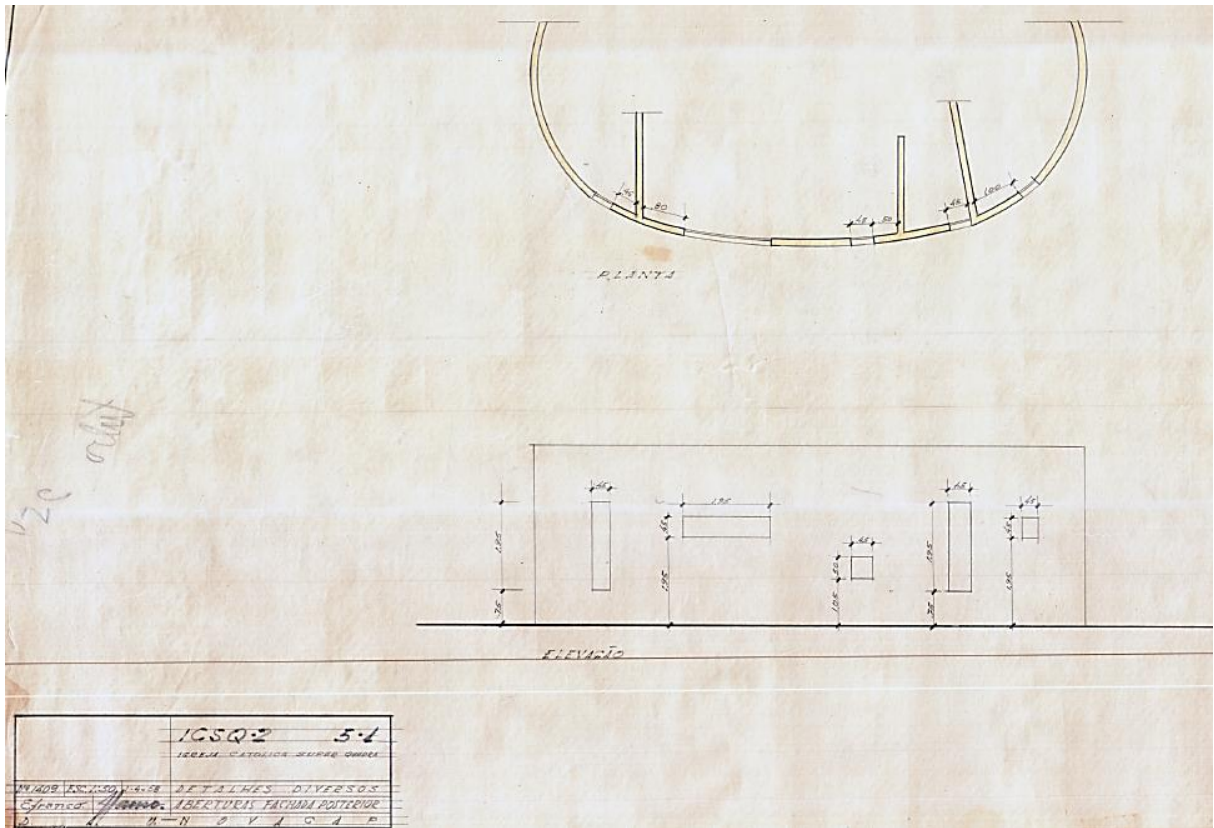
| Detalhes diversos – aberturas fachada posterior. 1.4.1958
